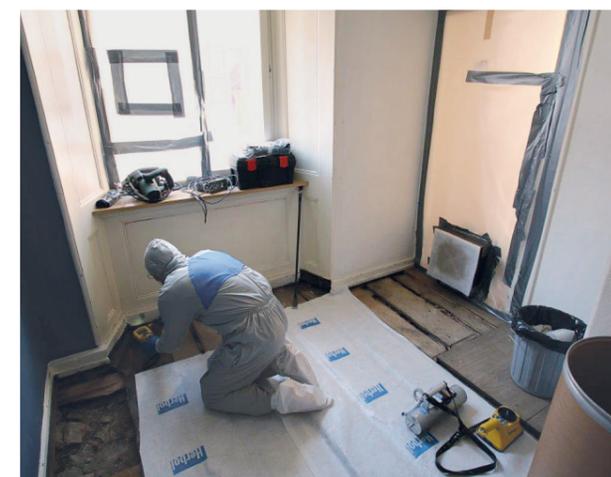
Assainissement d'un plancher contaminé au radium-226 à La Chaux-de-Fonds (Source : OFSP)
